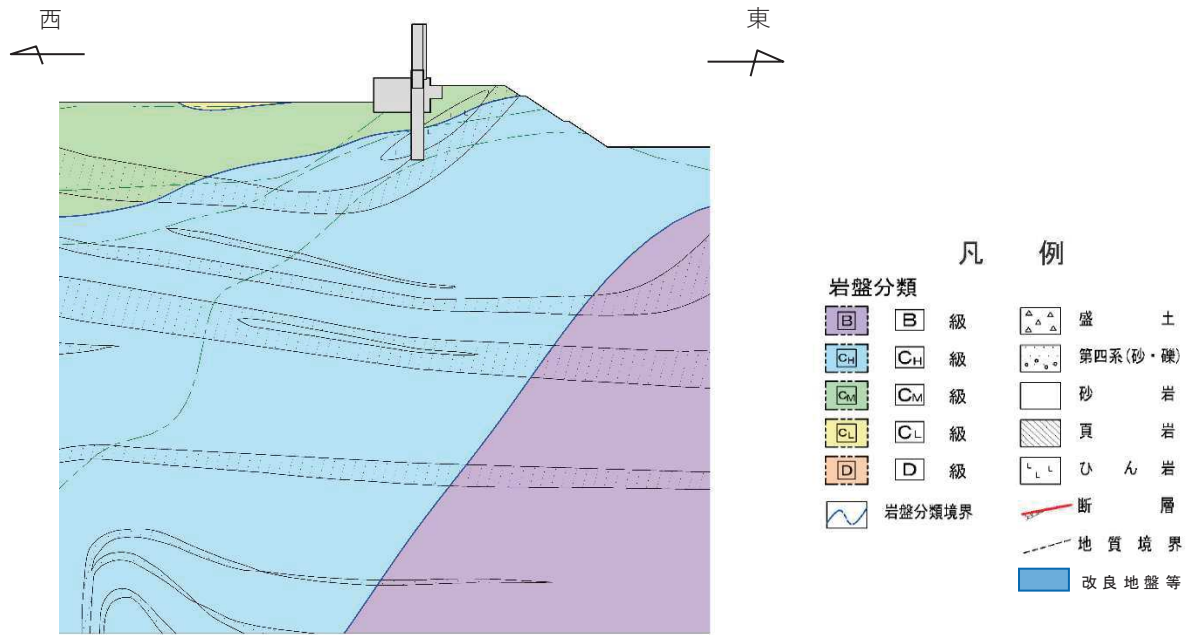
鋼管式鉛直壁（岩盤部）I-①断面（断面⑤）
